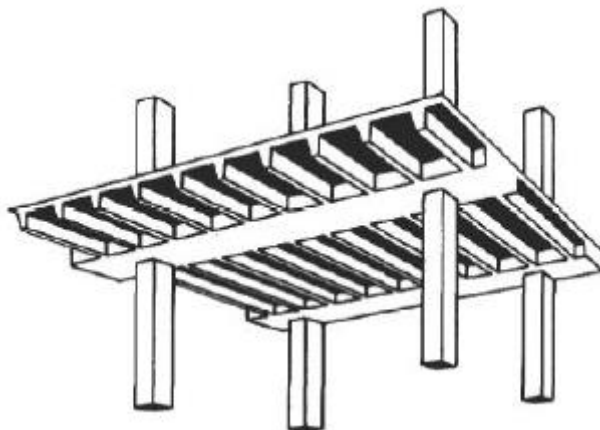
Lajes aligeiradas unidireccionais [B9]
